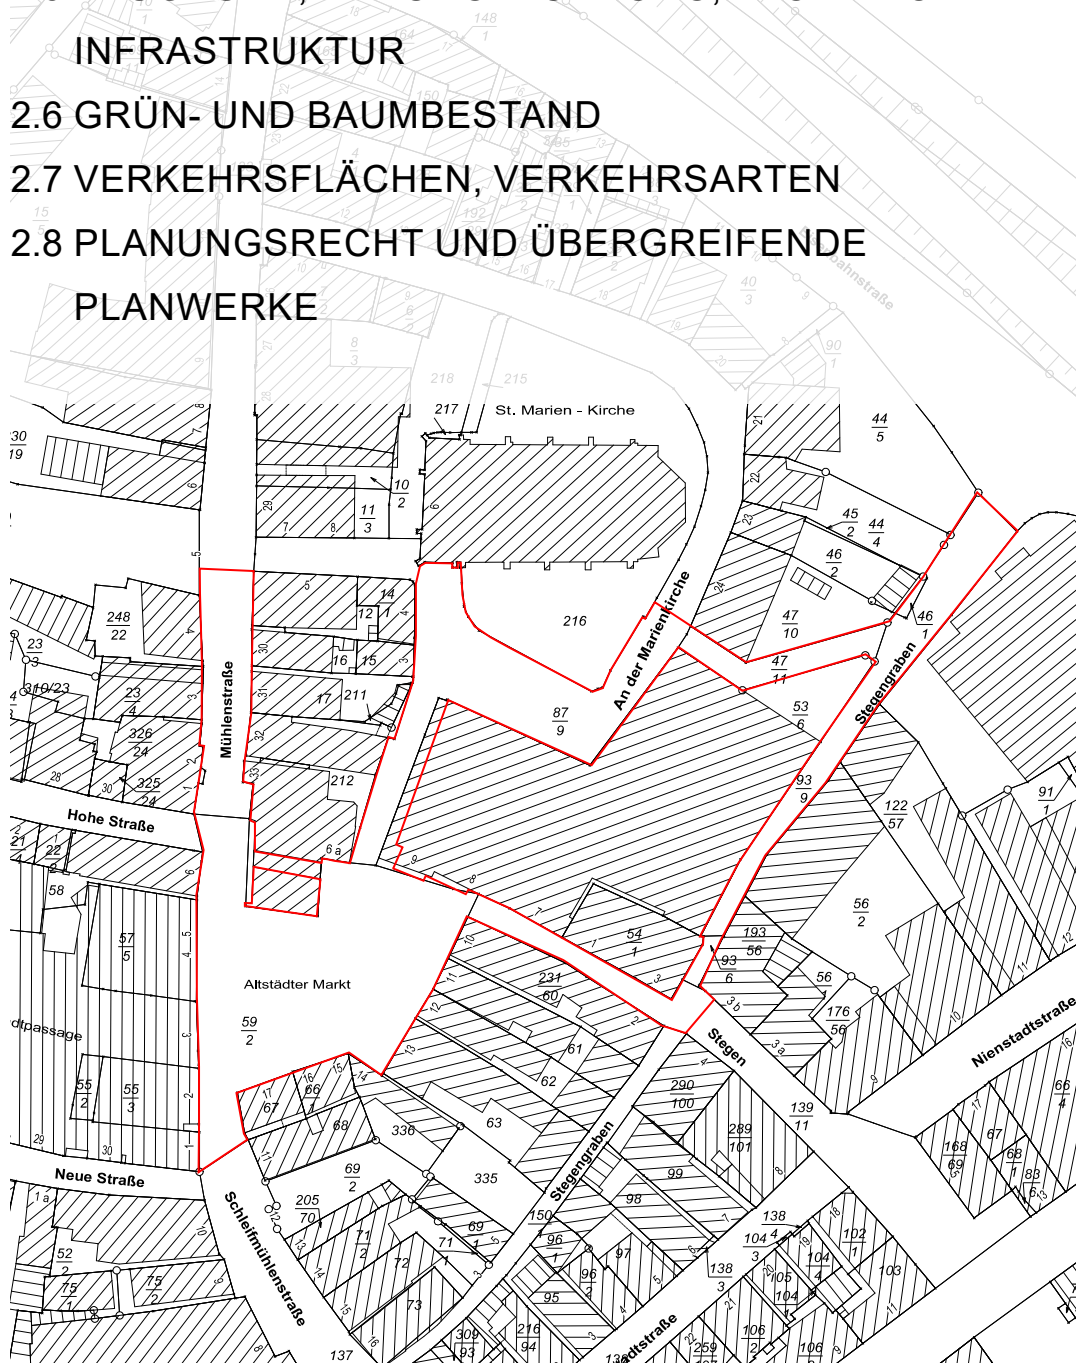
Katasterplan, Plangebiet rot umrahmt (Abbildung nicht maßstabsgetreu)
